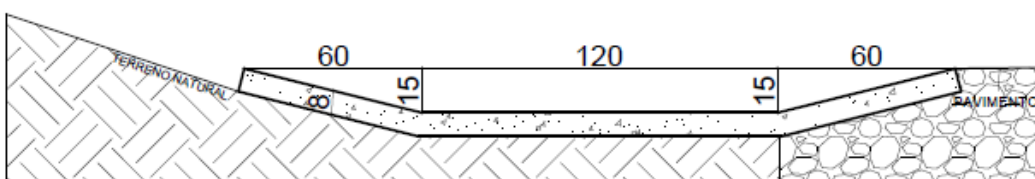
Sarjeta Trapezoidal de Concreto Revisada 02 (SZC 02-1r)
